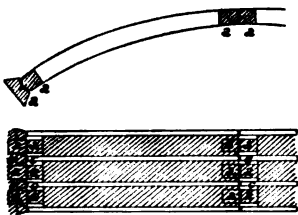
Betonierungsschema der Steyrflußbrücke.
